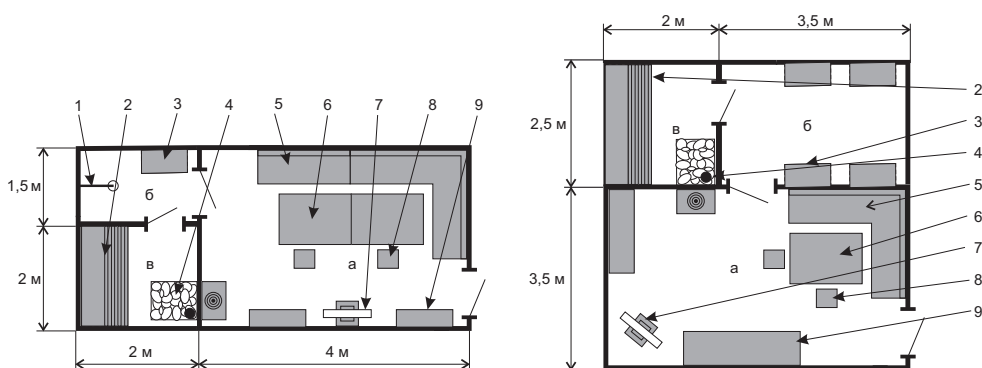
Проекты бань: а — предбанник; б — отсек для мытья; в — парилка; 1 — душевая; 2 — полки; 3 — скамьи; 4 — печь-каменка; 5 — мягкий уголок; 6 — стол; 7 — телевизор; 8 — табуретки; 9 — шкафы для одежды
